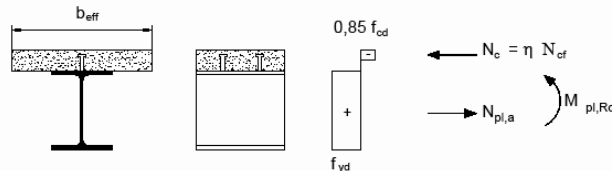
Distribuzione delle tensioni plastiche allo SLU per il calcolo del momento resistente positivo
